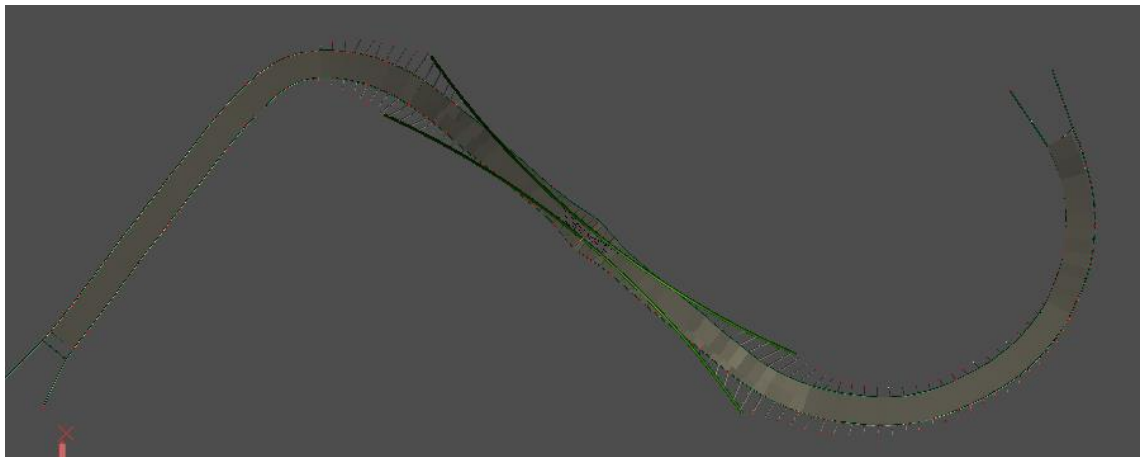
Vista en Planta de la estructura del puente [Elaboración Propia]
